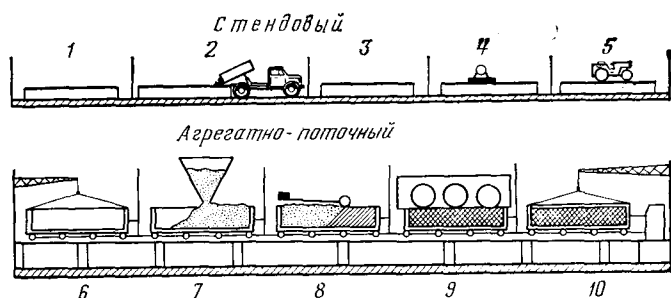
Способы формования дорожных асфальтобетонных плит:
